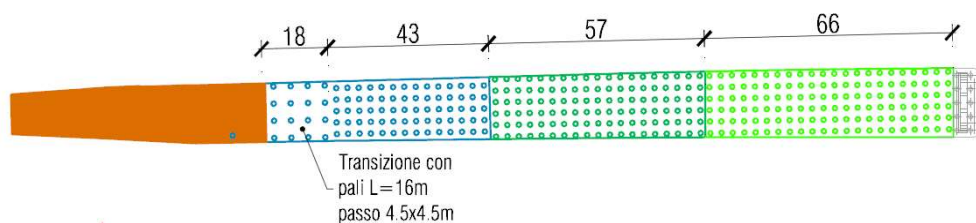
SCHEMA DISPOSIZIONE PALI – DIRADAMENTO ZONA DI TRANSIZIONE
